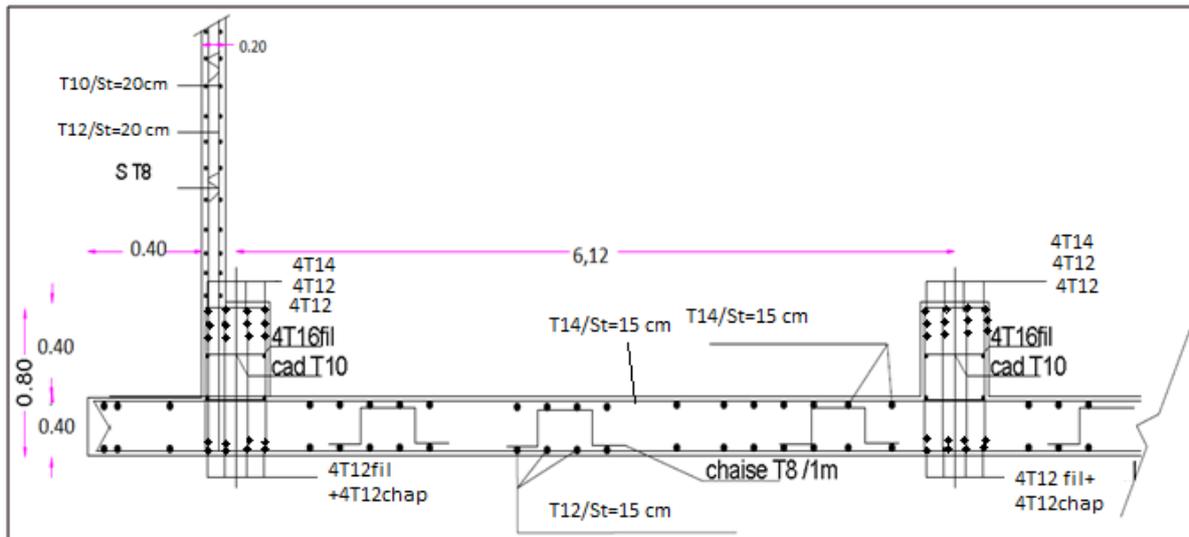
Ferrailage de la poutre de libage et le radier et voile périphérique suivant le sens transversale
